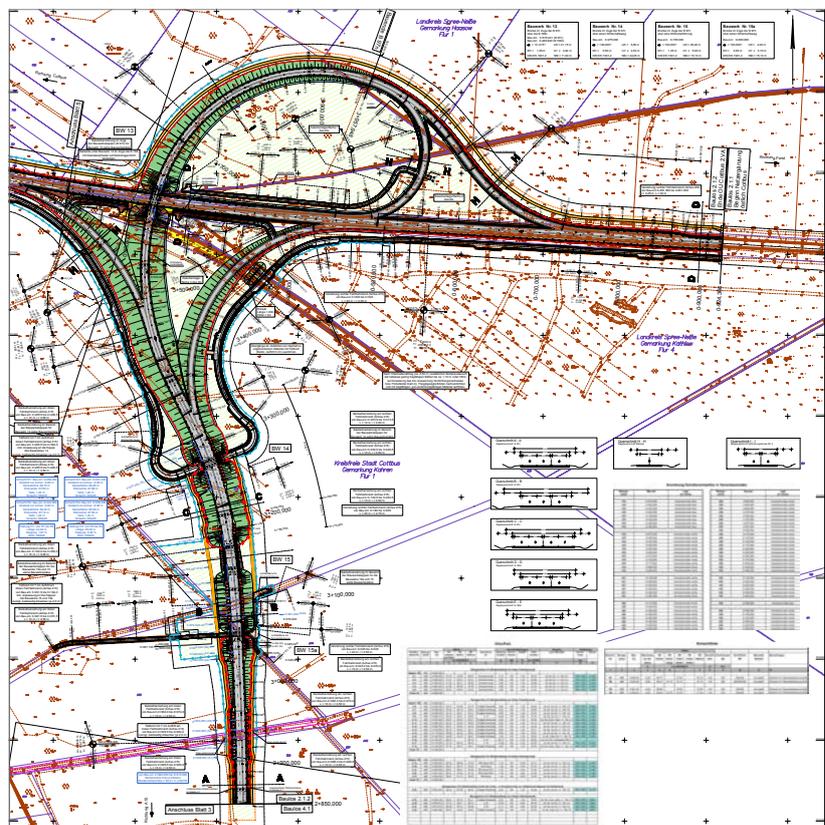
Lageplan Baulos 2 neuer Knotenpunkt (KP 4) B 168/B 97n
